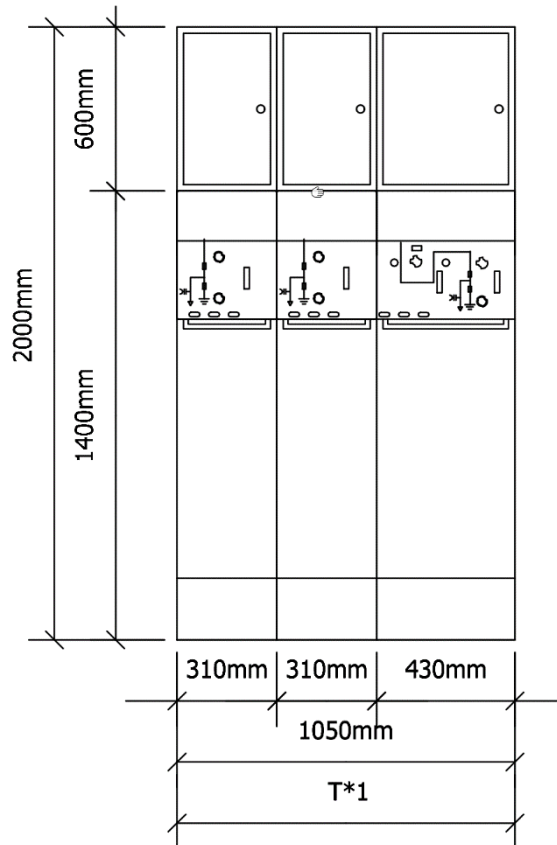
Vista frontal do Bloco Rede Anel equipado com aparelhagem de 630 A
